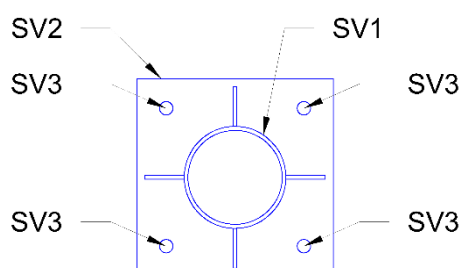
Esempio schema strutturale: sezione orizzontale palo con vista su piastra di base
